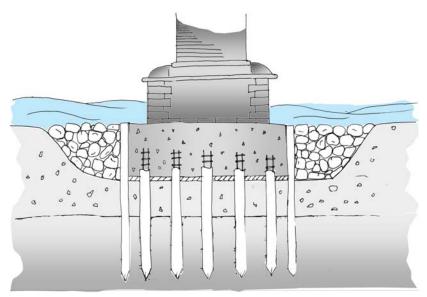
Cimentación profunda con pilotes de hormigón armado.
